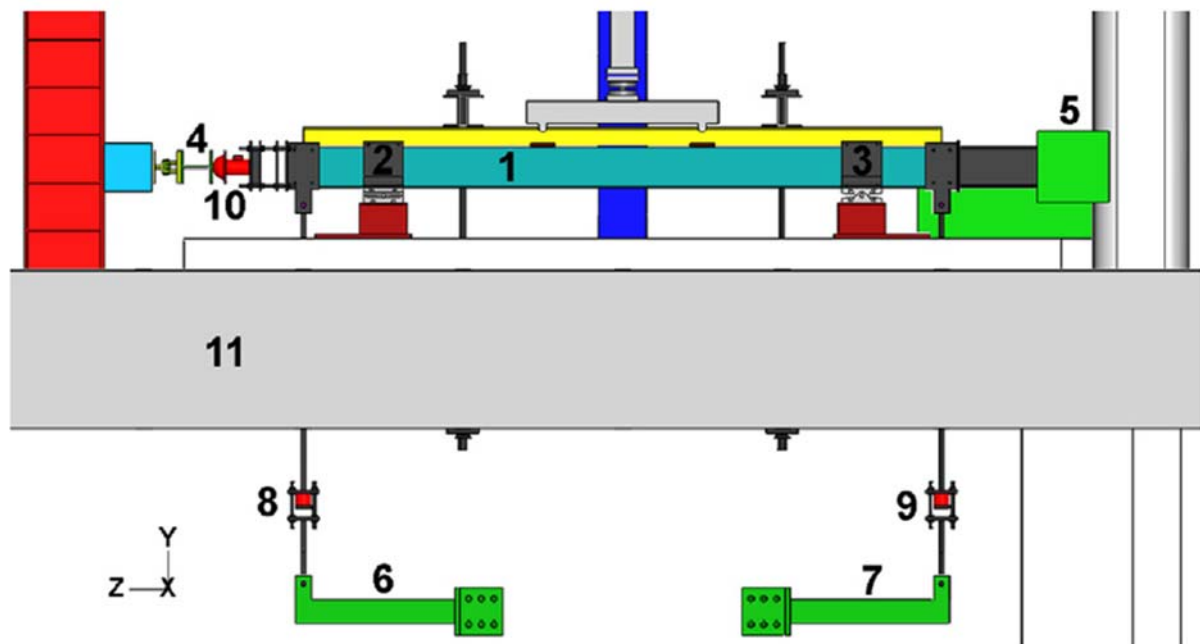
Pormenor do sistema de restrição axial e rotacional dos ensaios experimentais: 1 – provete; 2 – apoio simples; 3 – apoio duplo; 4 e 5 – restrição axial da viga; 6 e 7 – restrição rotacional da viga; 8, 9 e 10 – célula de carga; 11 – laje de betão (Láim *et al.* 2015).
